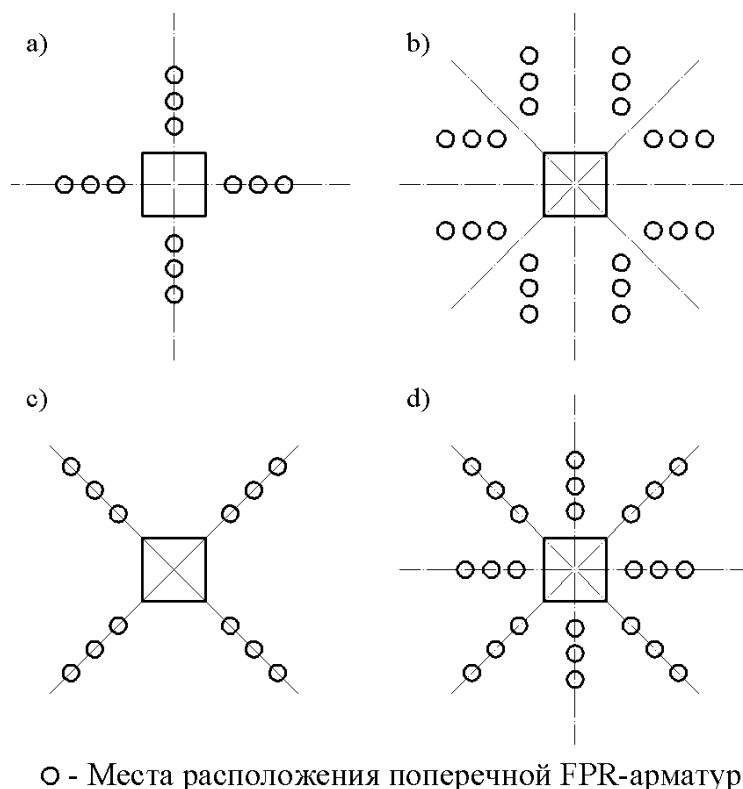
Варианты схем поперечного армирования плиты вокруг колонн [9]
